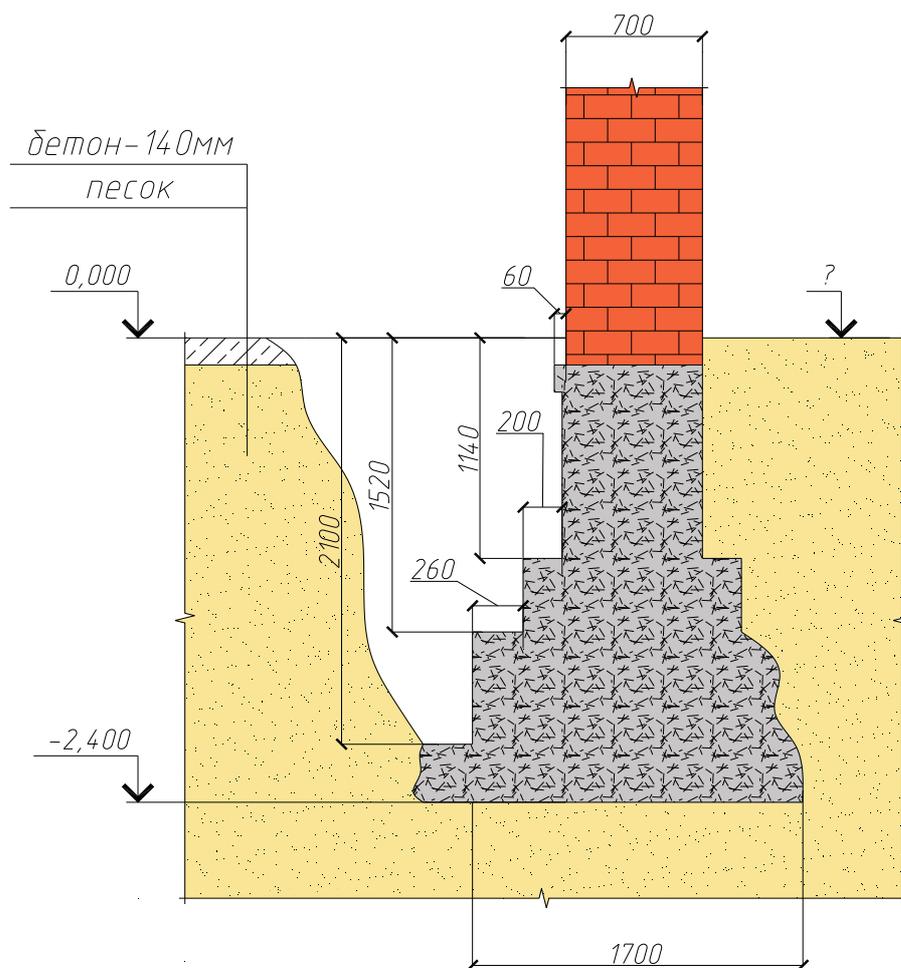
Эскиз поперечного сечения фундамента.
